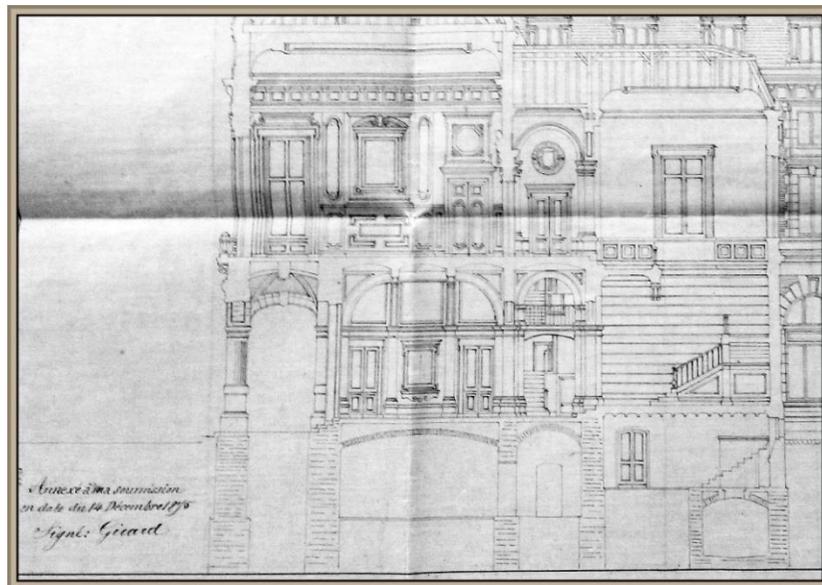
Girard, *Coupe longitudinale (détail)*, 1875
